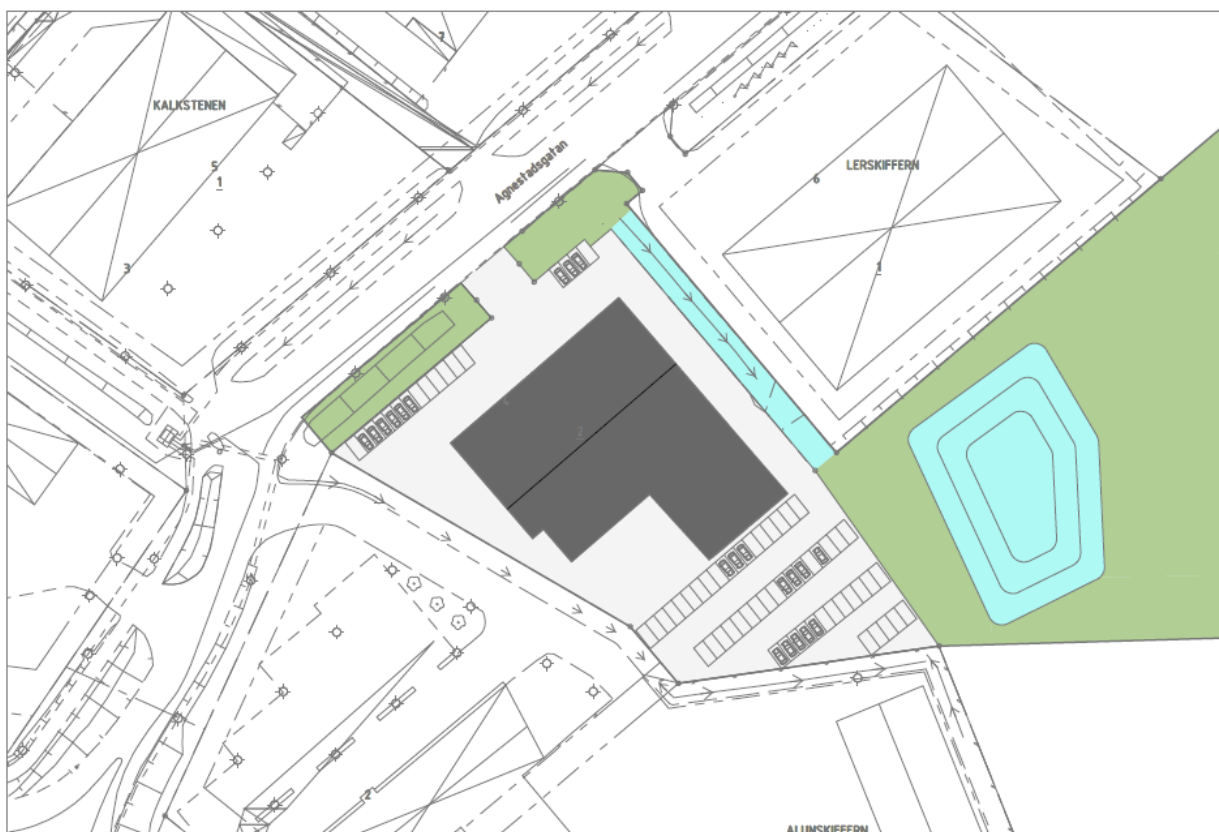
visar en illustration över planområdet och ett möjligt genomförande av detaljplanen.
